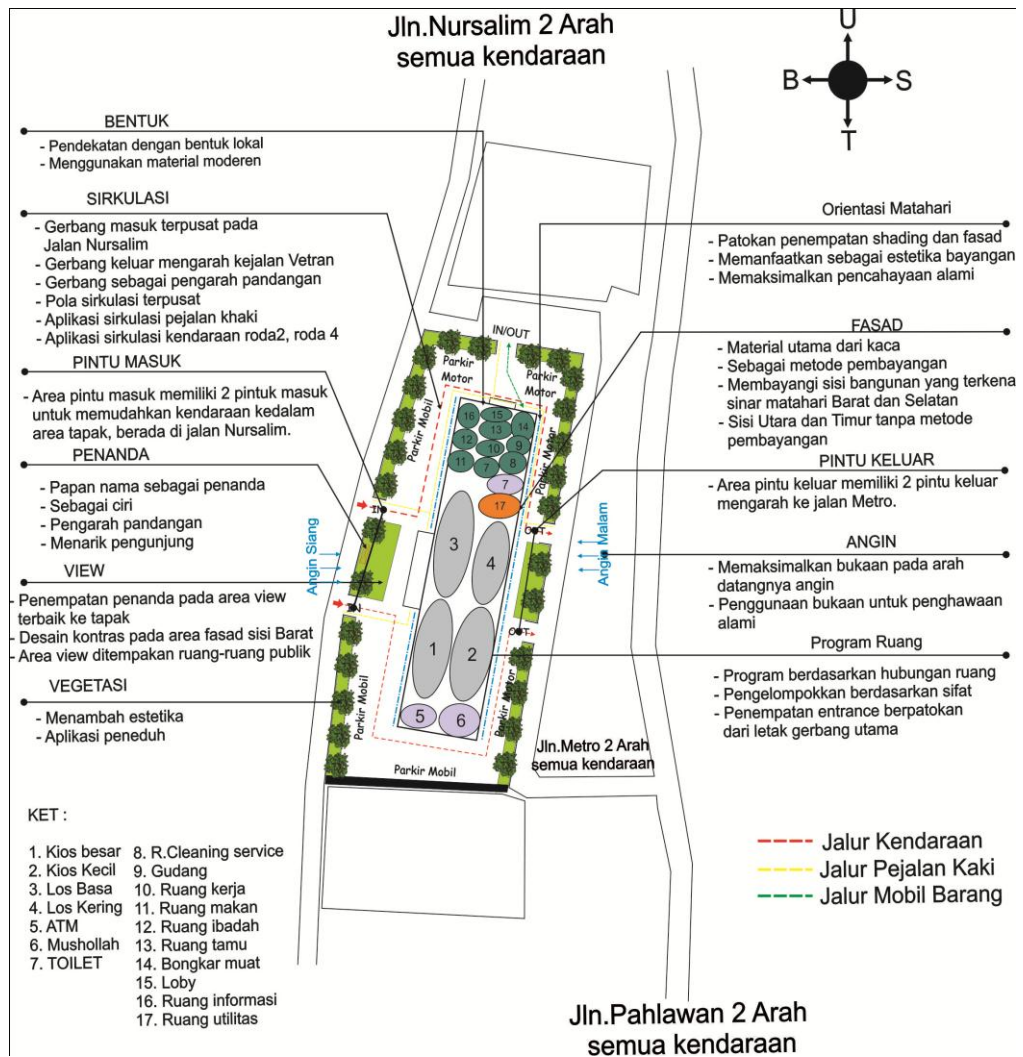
Hubungan Ruang Fungsi Utilitas
